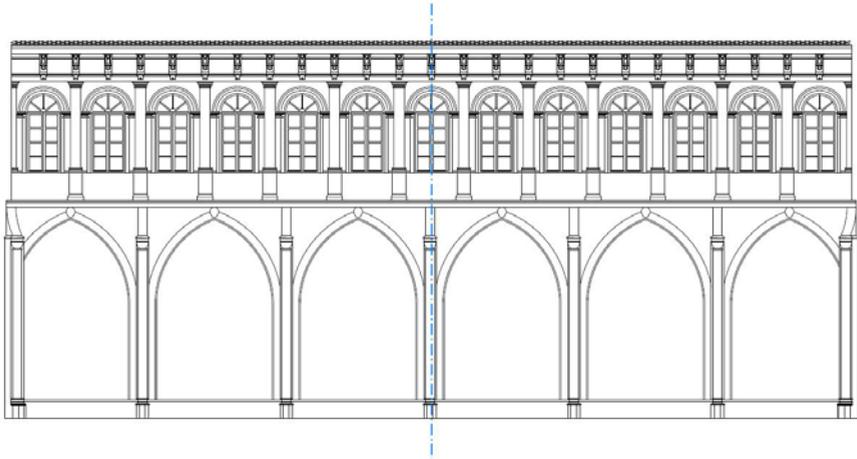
Alzado Oeste del Claustro Mayor. 2016. Plano del autor.
